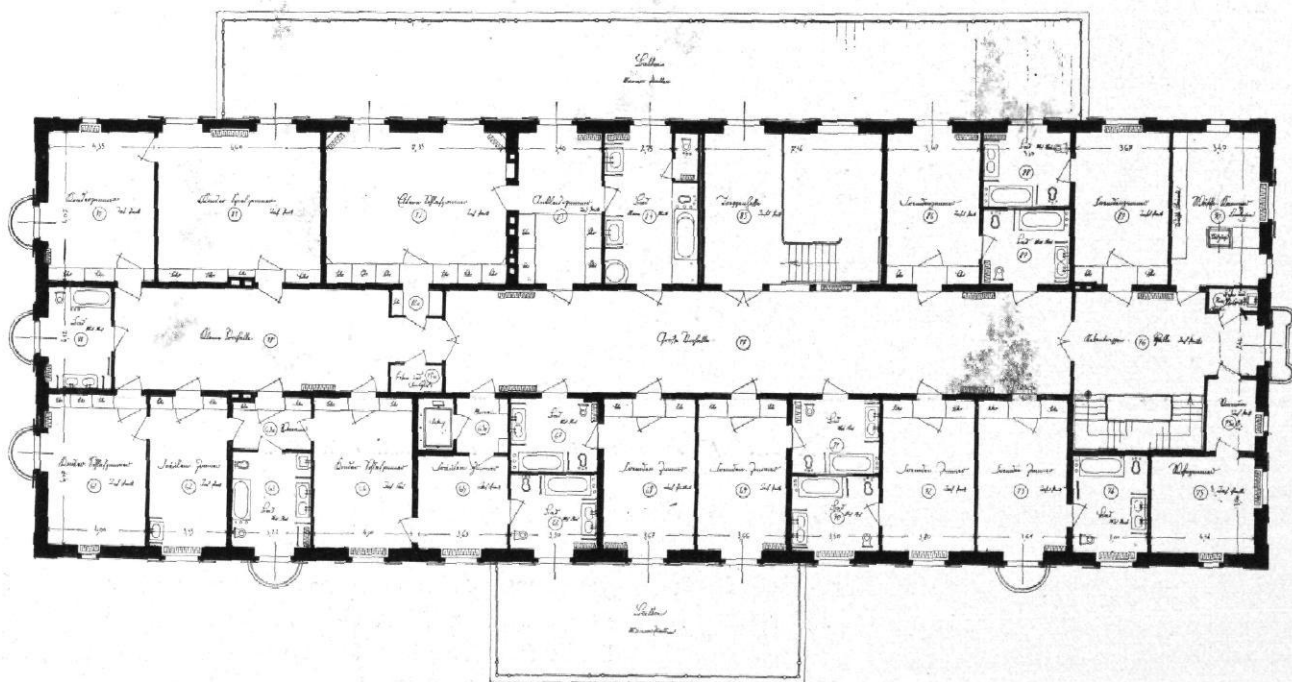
/ Herrenhaus Hobeorst / Architekt: Otto Blendermann, Bremen / Grundriß des Obergeschosses 1 : 300
